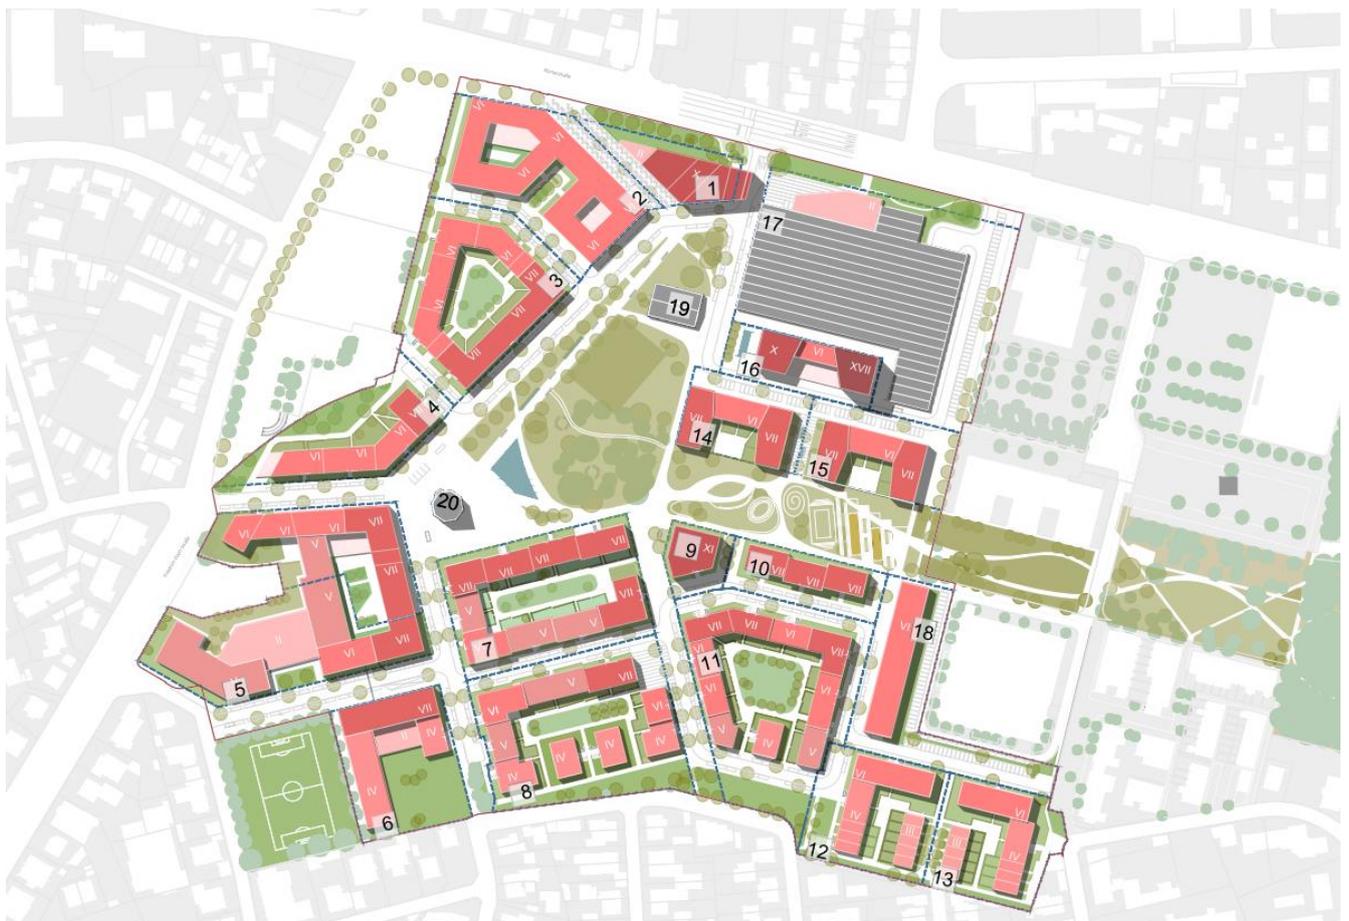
Lageplan – INquartier Ingolstadt (Quelle: kister scheithauer gross architekten und stadtplaner)
